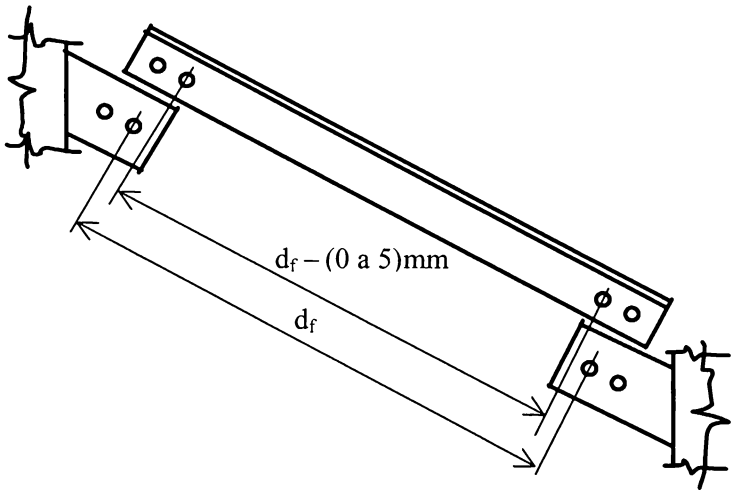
Barras de Contraventamento Montadas com Pré-tensão
